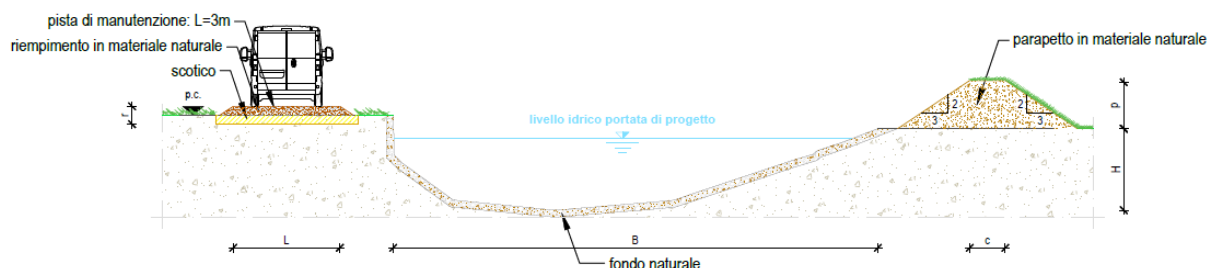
Sezione tipologica di progetto del tratto CIR-03-03 – completezza dell'intervento.
